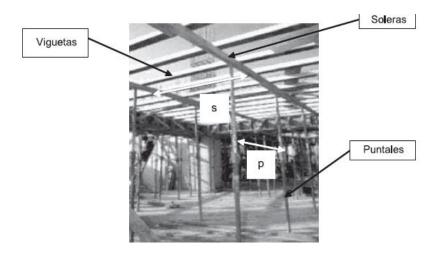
Izaje de las viguetas prefabricadas Firth en obra parte II.
